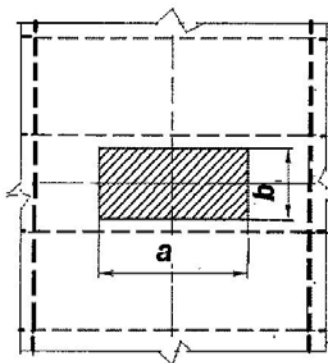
Площадка навантаження для пластини
